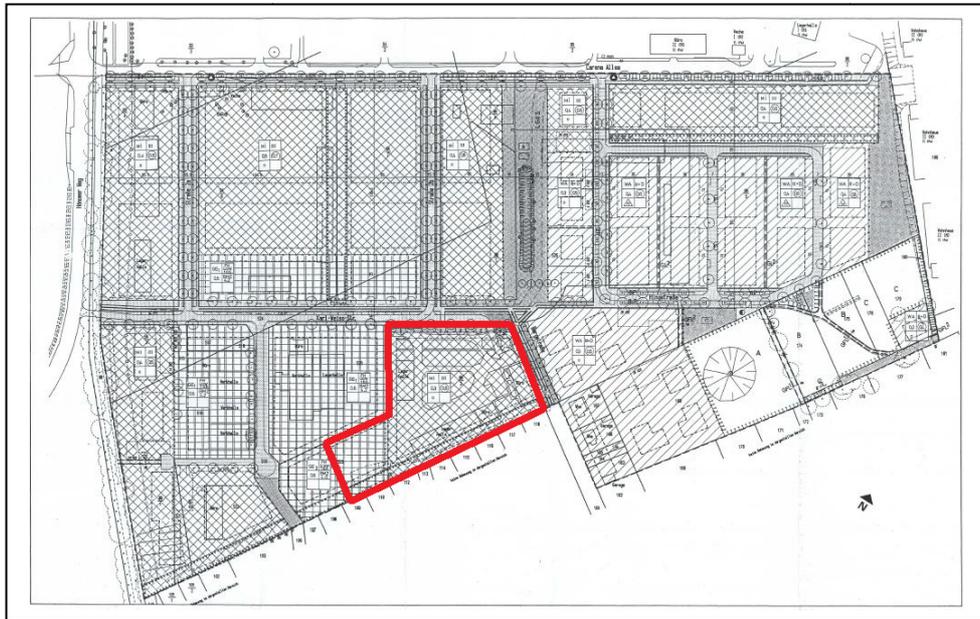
Lage der 5. Änderung im Bebauungsplan „Obere Bergstraße“
